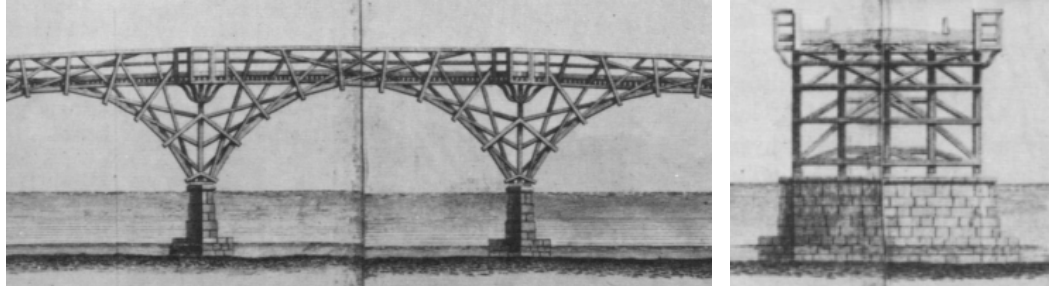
Diseño para el Puente de Westminster. Inglaterra. 1737. James King.
